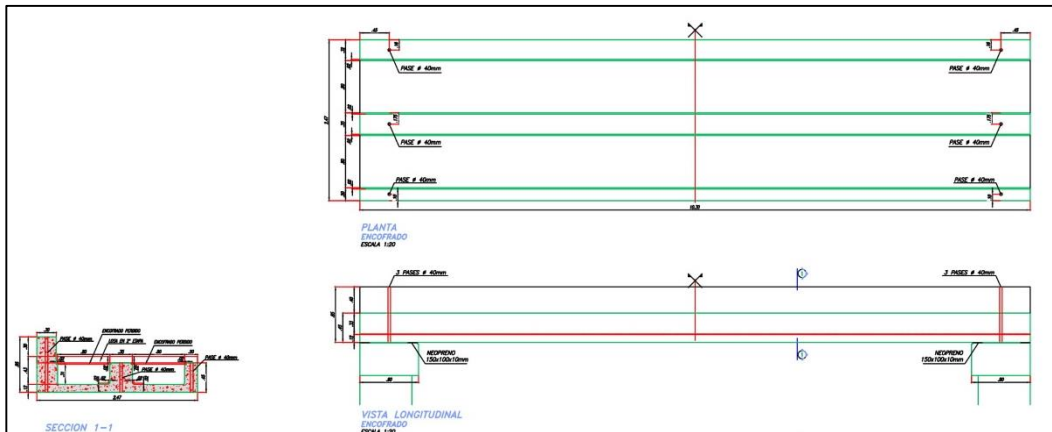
Detalle de viga doble cajón de servicios varios. (PLANO N° 21)
